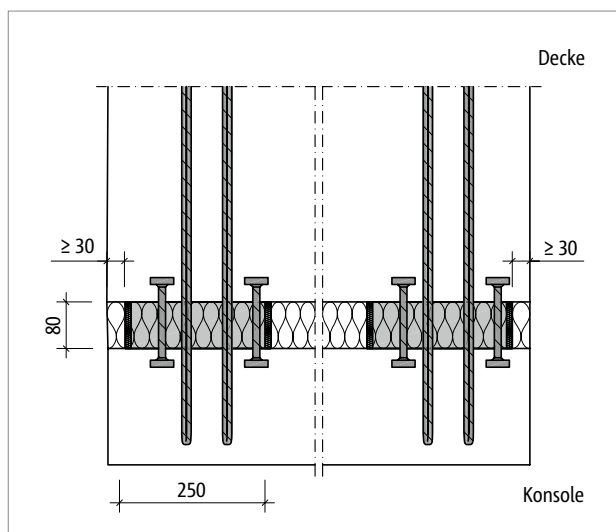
Schöck Isokorb® T Typ OP: Einzuhaltender Randabstand
